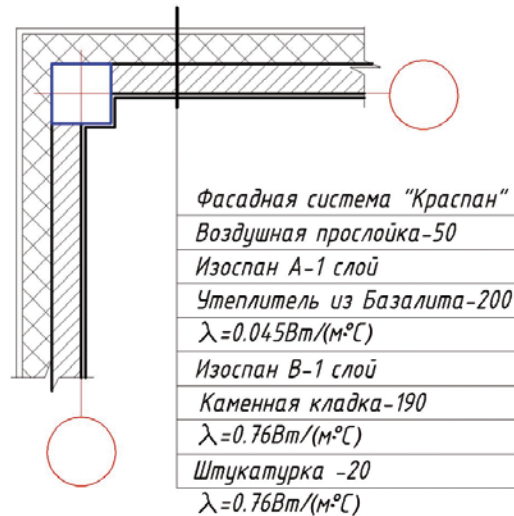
Эскиз угла наружных стен с вентилируемым фасадом многоэтажного каркасного здания
